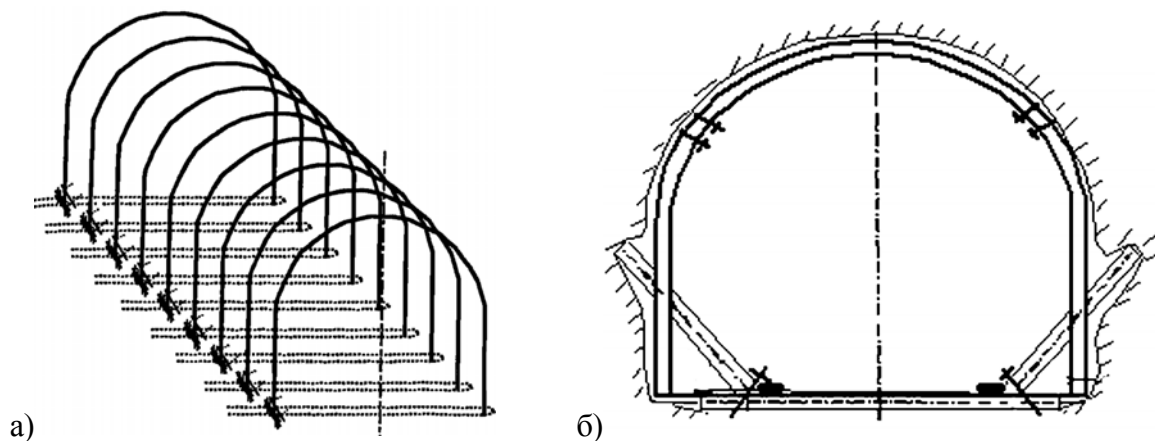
Схемы расположения: ножек арочной крепи со спаренными канатами (а) и схема установки и конструкция лежня с упорами (б)
